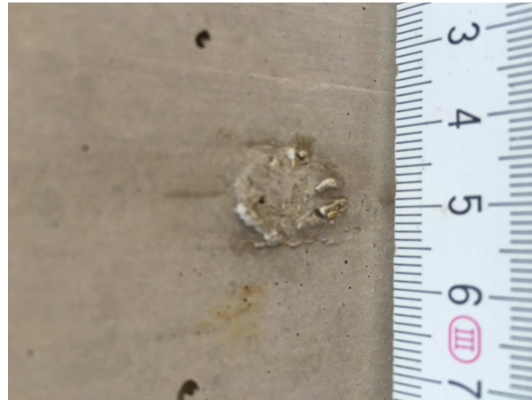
Wirkung: Abzeichnen der Schraubenköpfe auf der Betonoberfläche
